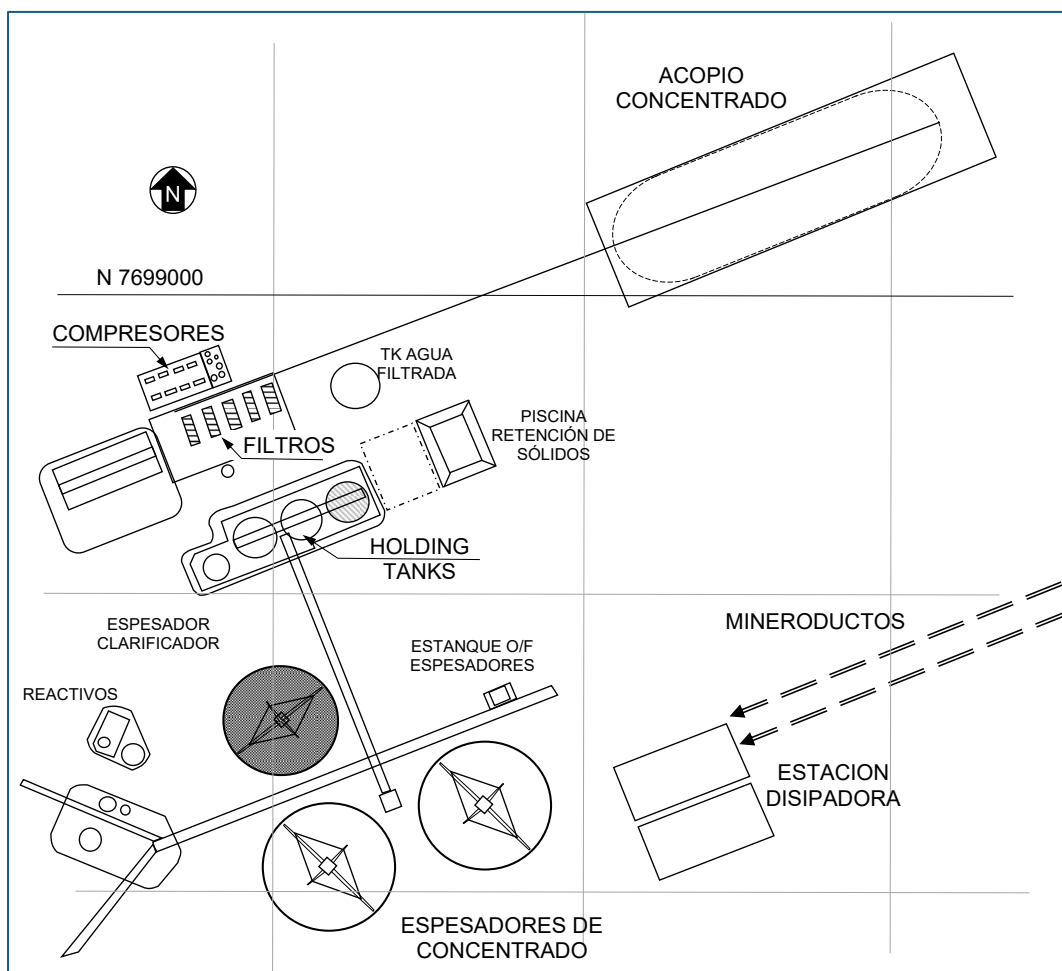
Esquema Simplificado Plot Plan Punta Patache Planta de Filtros Collahuasi
